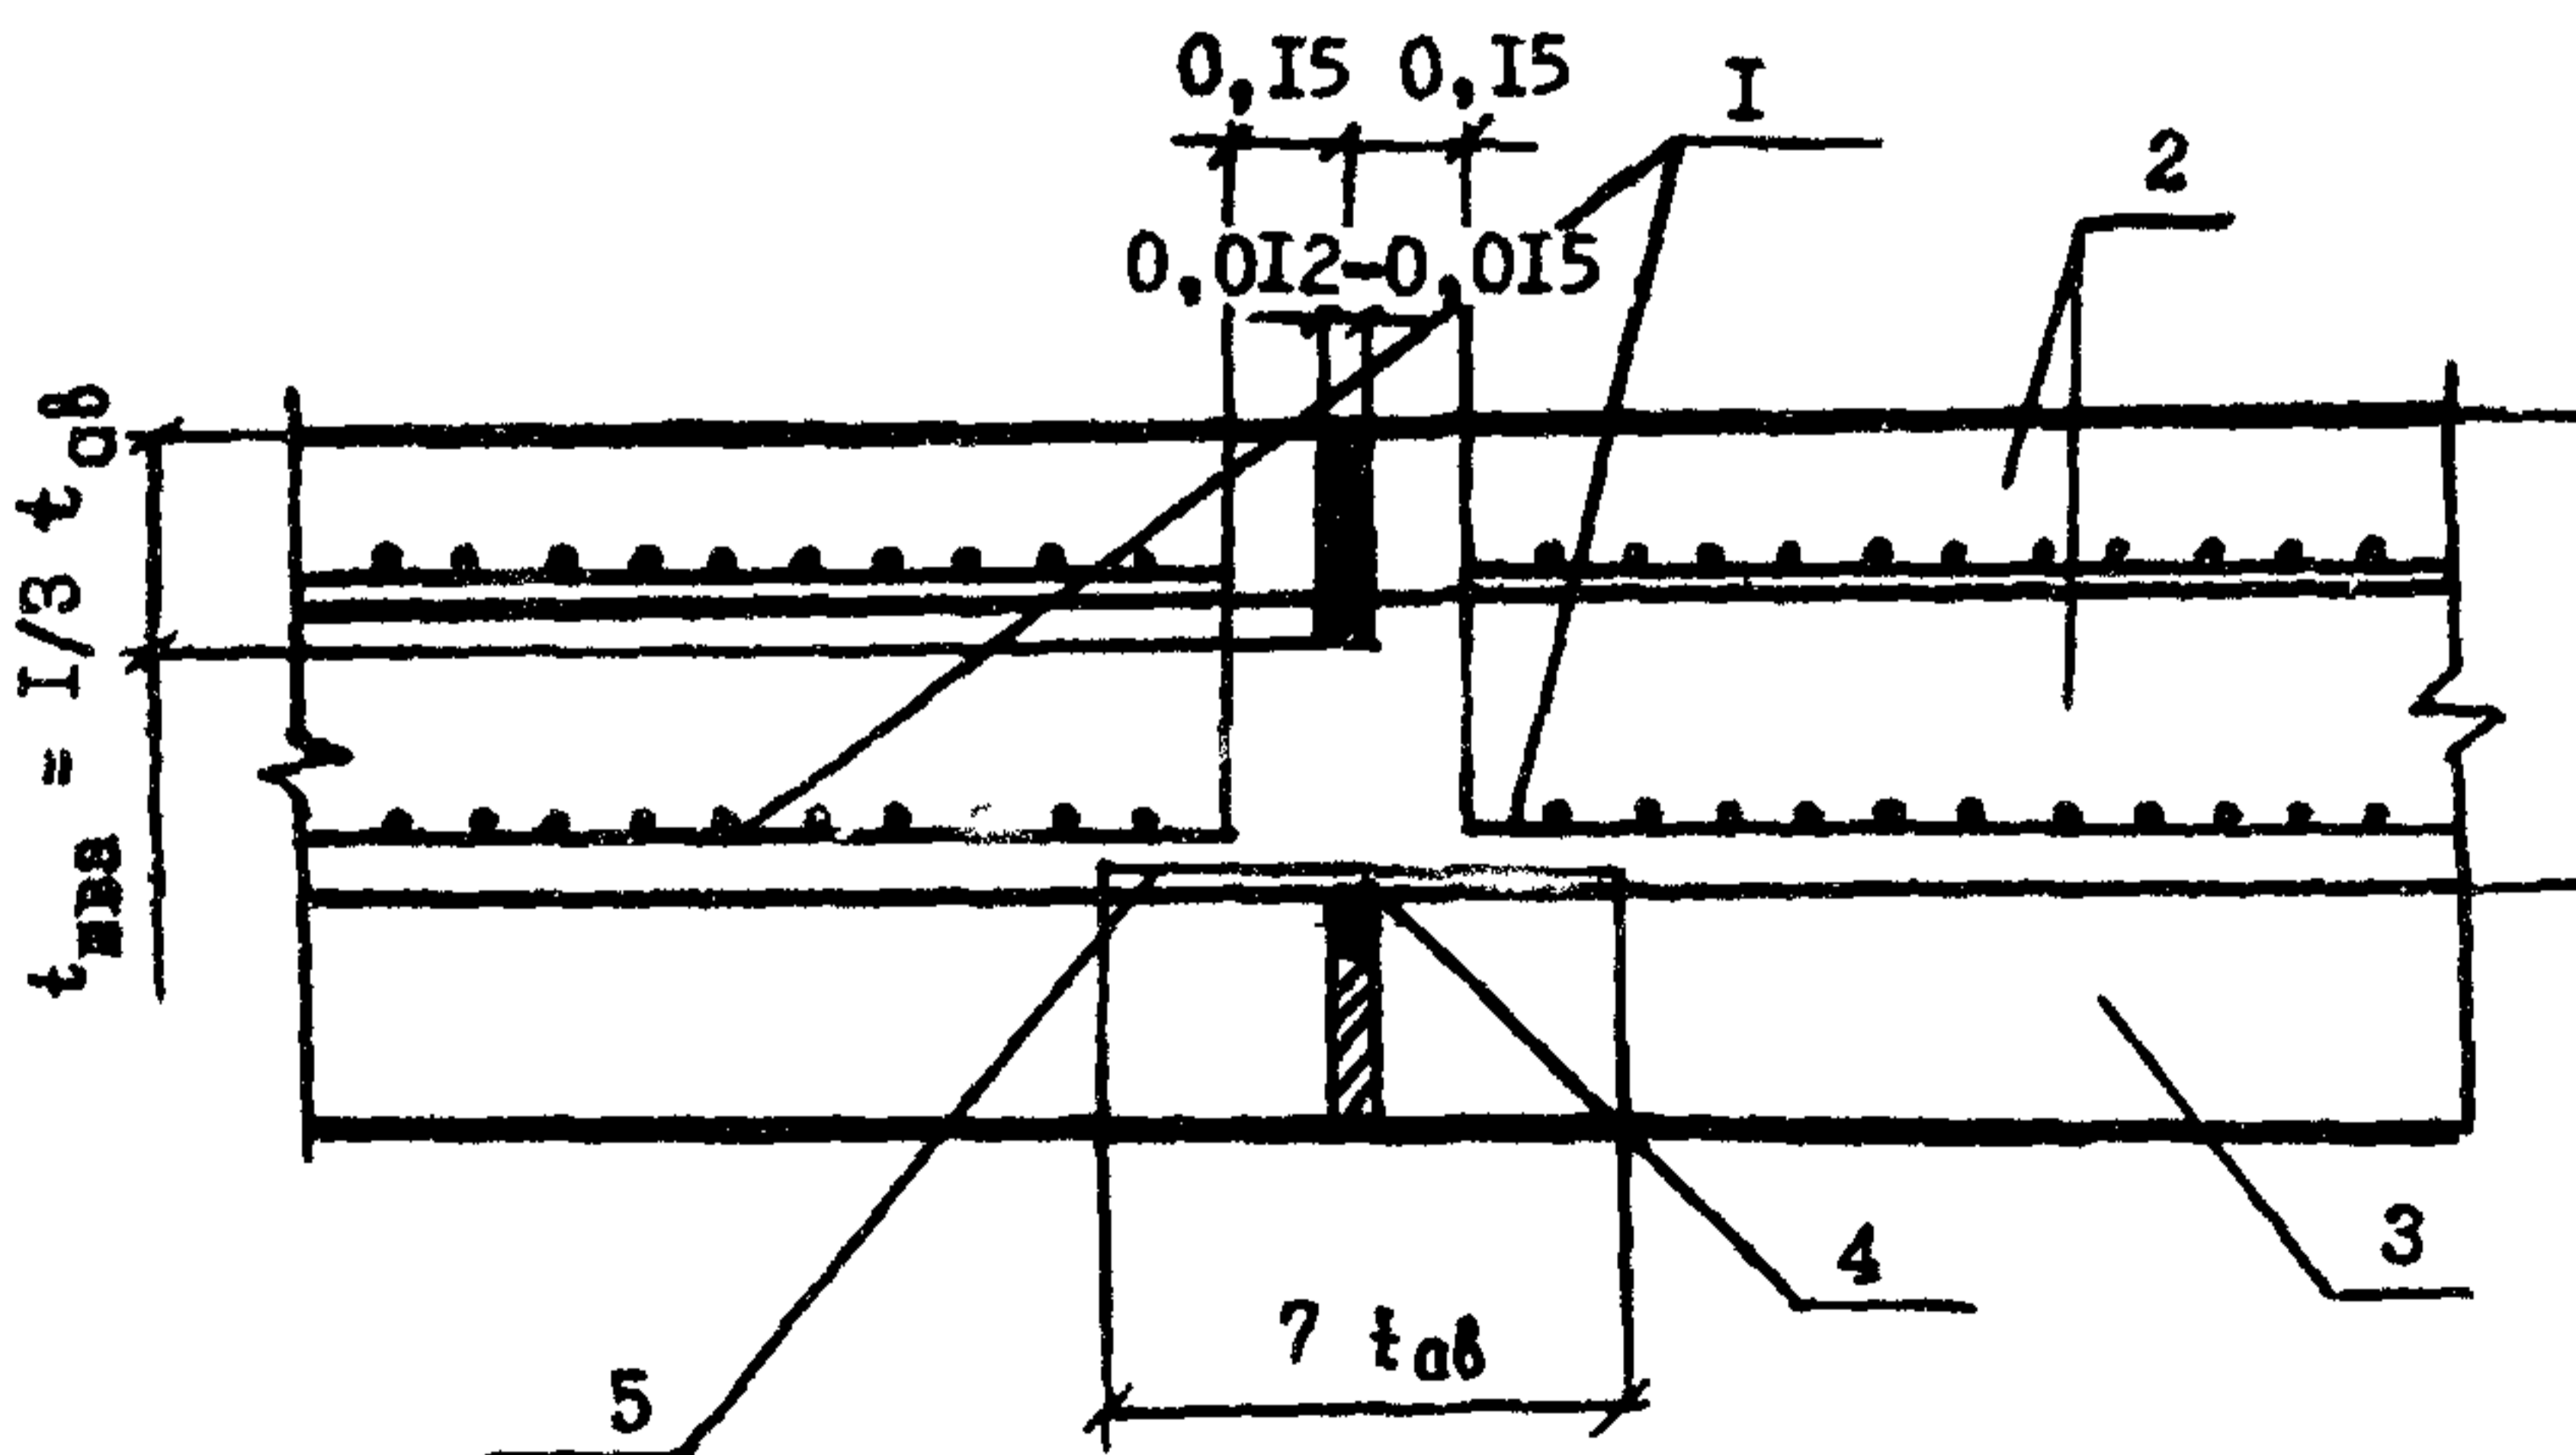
Двухслойное асфальтобетонное покрытие: I – стеклопластиковые сетки; 2 – слой усиления из асфальтобетона; 3 – существующее жесткое покрытие; 4 – побелка известковым молоком; 5 – пергамин
